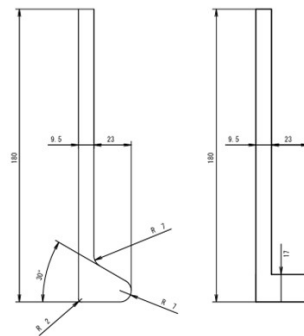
バルブプレートの断面図（左）と簡素化した断面図（右）
